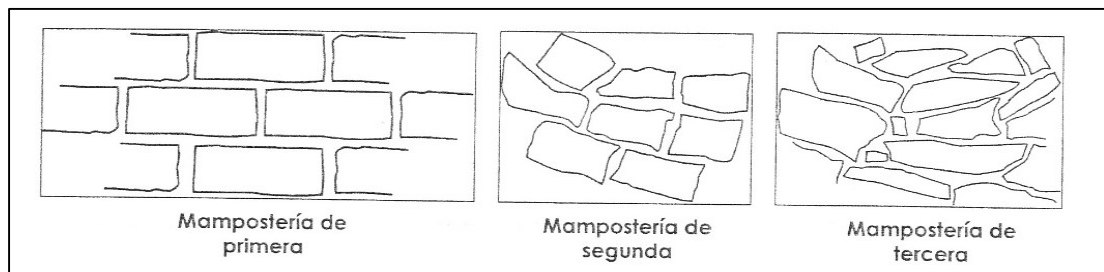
Tipos de mampostería de piedras naturales. (Fuente: Sociedad Mexicana de Ingeniería Estructural, A.C.; 1999: 20)
